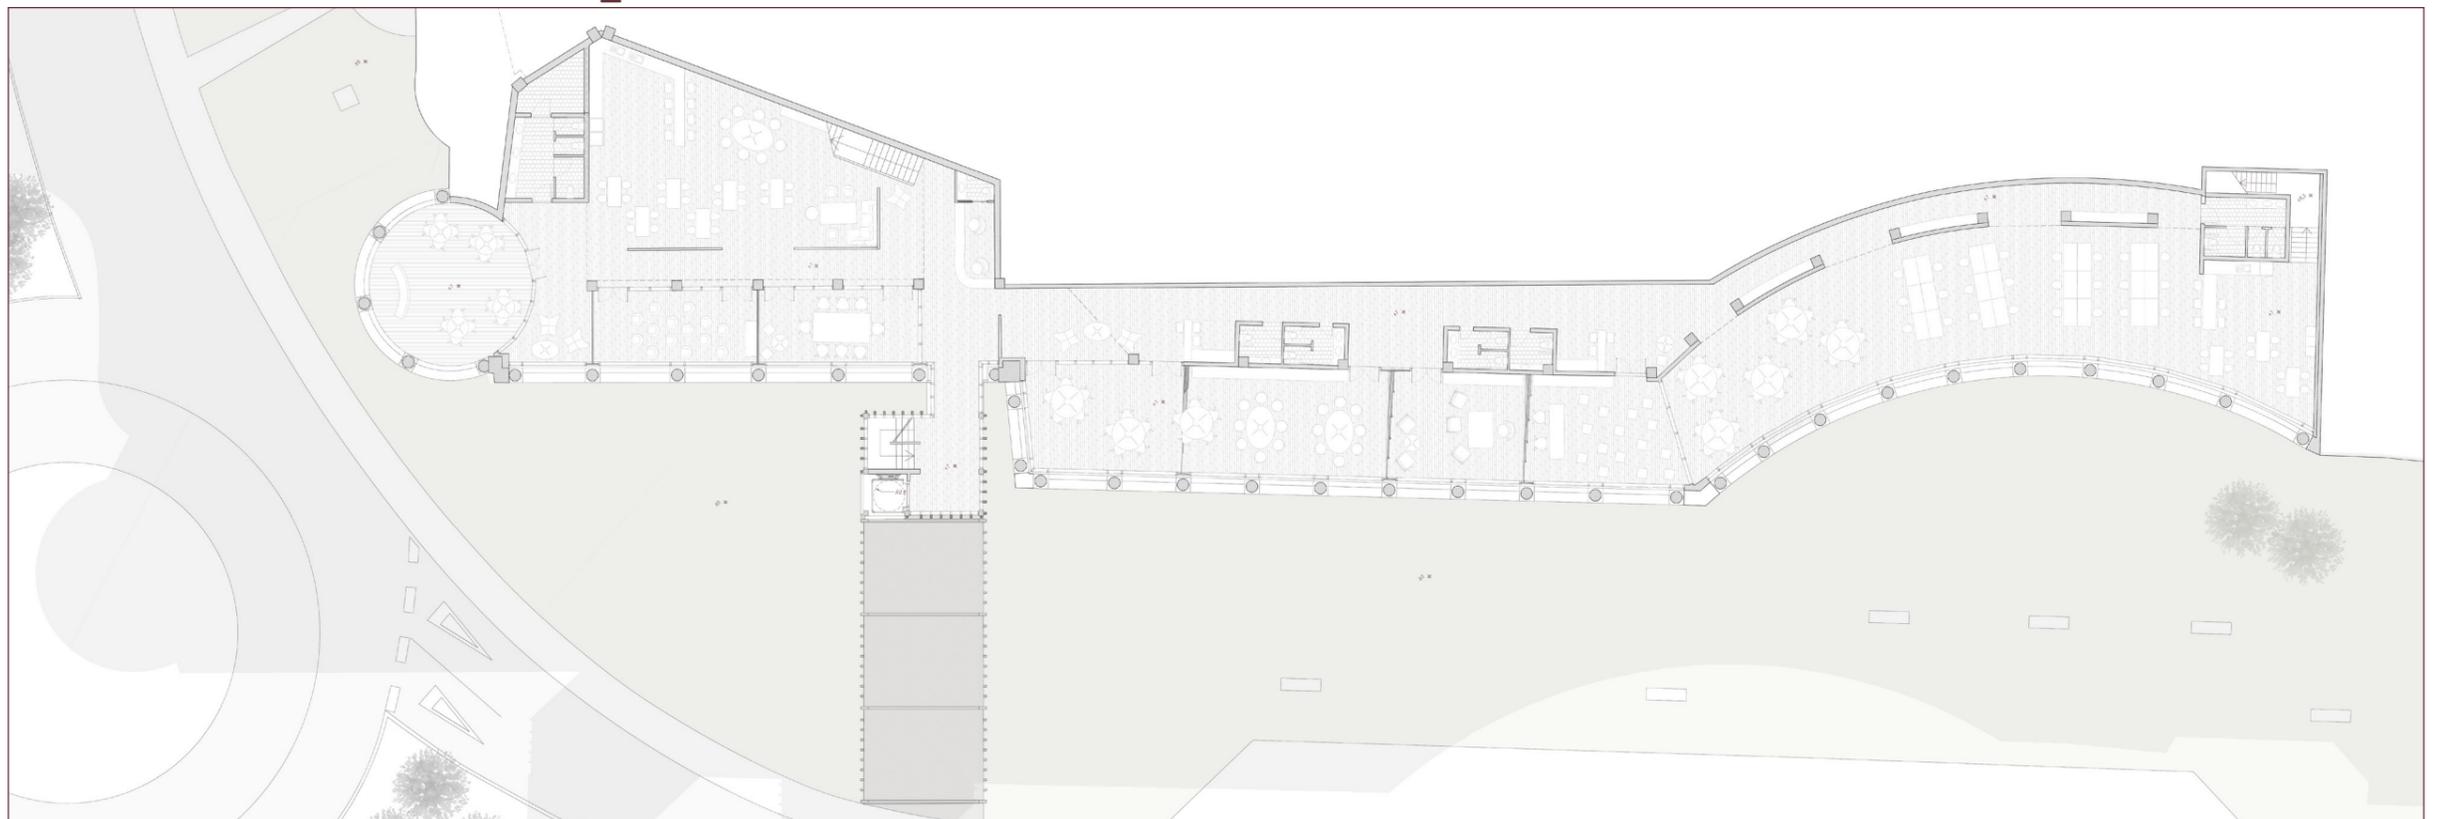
Planta de la galería suroeste, donde se sitúa el espacio coworking.
